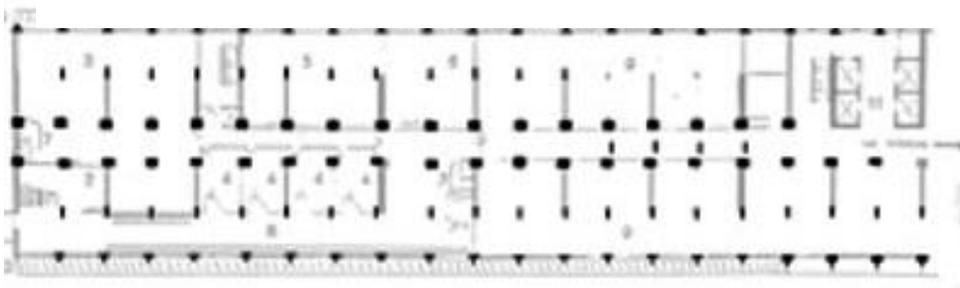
Planta alta edificio de vivienda Marsella. Fuente: Internet. S/E
